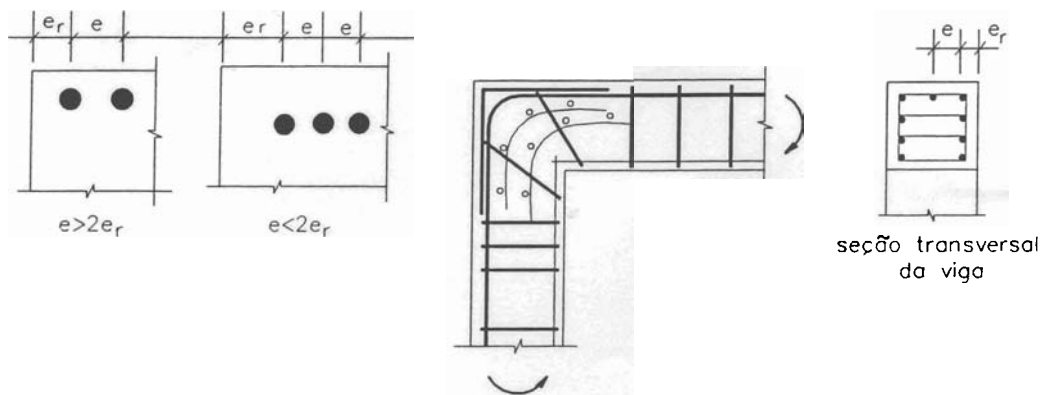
Detalhe de armadura de ligação viga de cobertura - pilar extremo para momento fletor tracionando as fibras externas, adaptado de LEONHARDT & MÖNNIG (1978)
